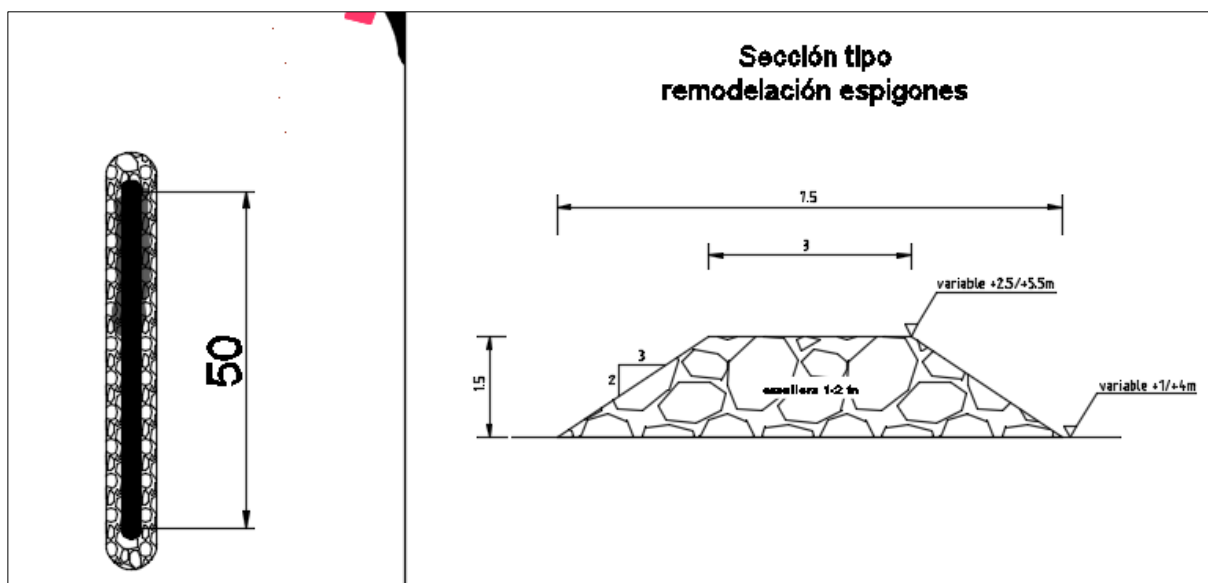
Detalle del recrecimiento de los espigones. Planta y perfil tipo.
